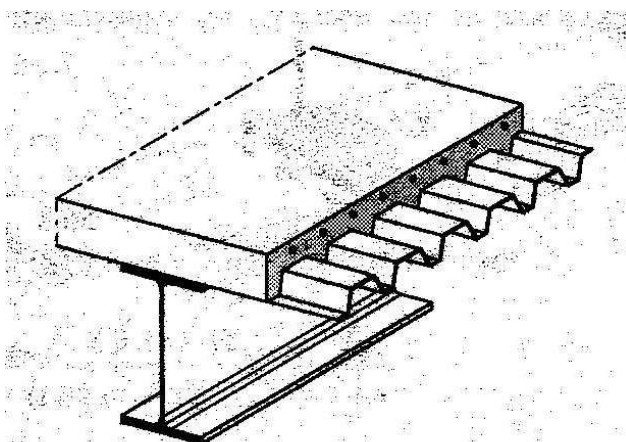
Forjado mixto de chapa colaborante con viga mixta acero – hormigón
